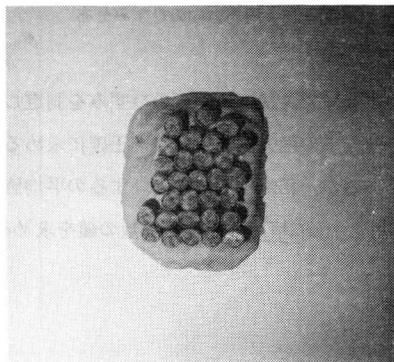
試験体の加熱前のグループケーブルの状態(加熱側)
